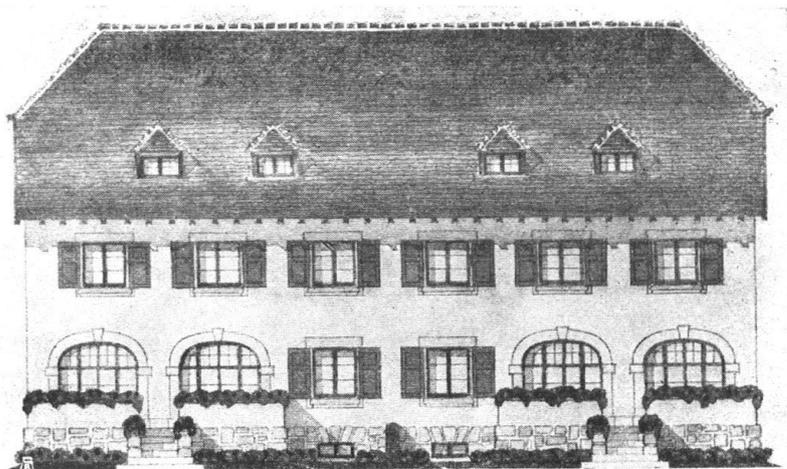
Projet „L. M. V.“ Type C. Façade sud.
